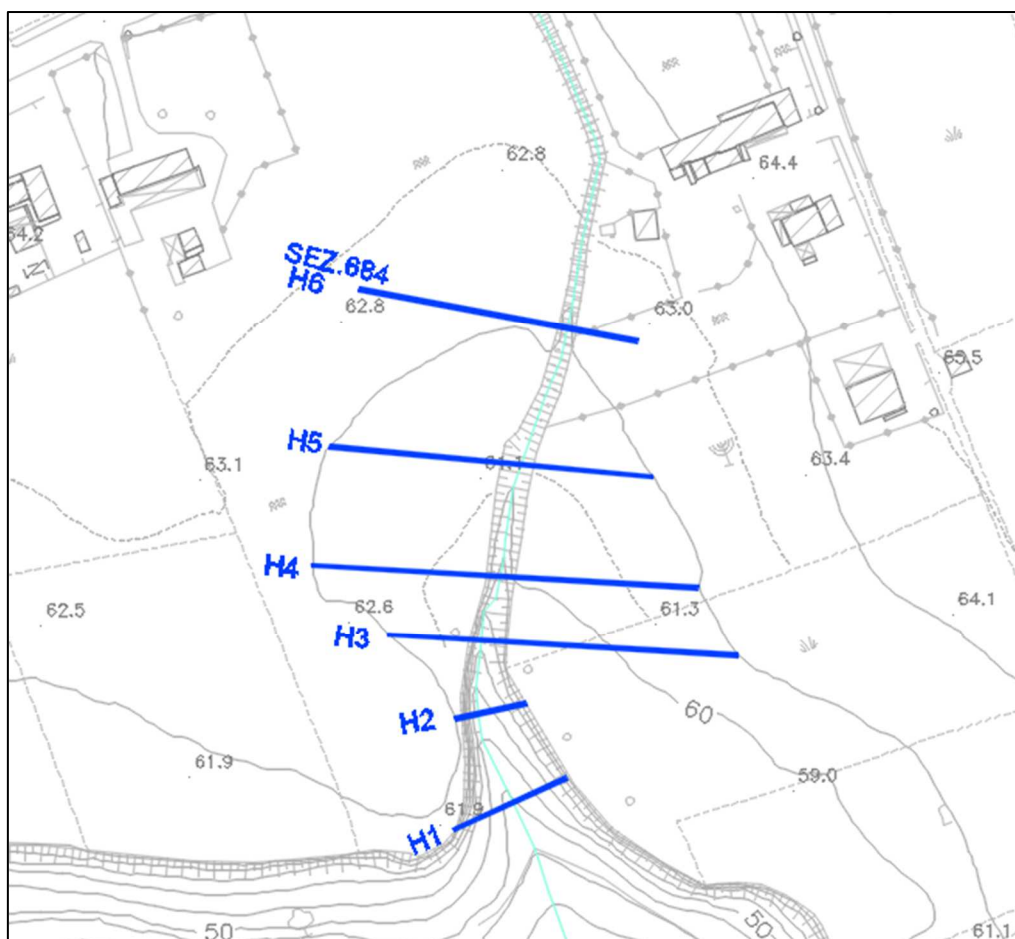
Inalveazione pk.22+950 – Stato Attuale – RAS - Ubicazione sezioni
